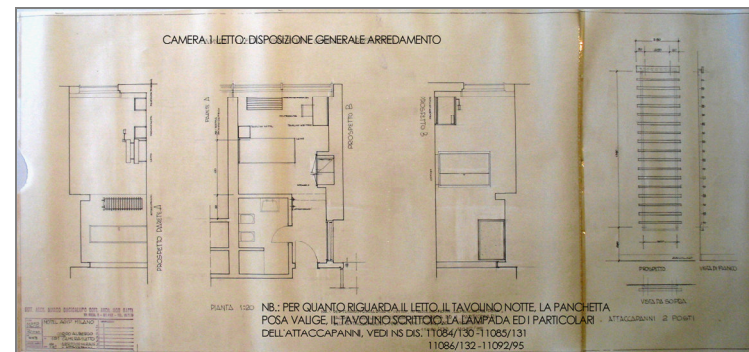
camera 1 letto (fonte CSAC – stralcio tav. 151, archivio n. 181-1, rielaborazione f.m.)
